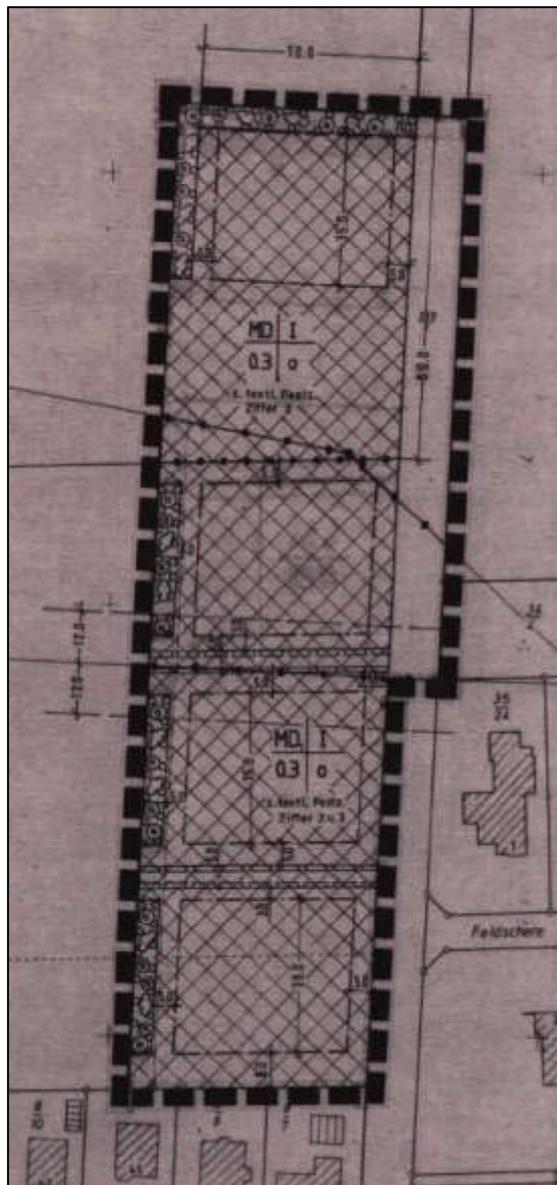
Auszug des Bebauungsplans Nr. 36 "Uhlenkampsweg"
